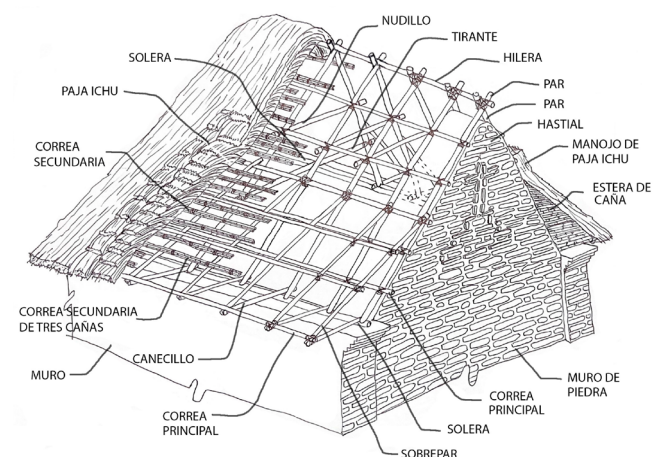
Elementos constructivos en madera, caña, paja y atados de cuerdas de pieles en la cubierta de la iglesia (dibujo de los autores)
